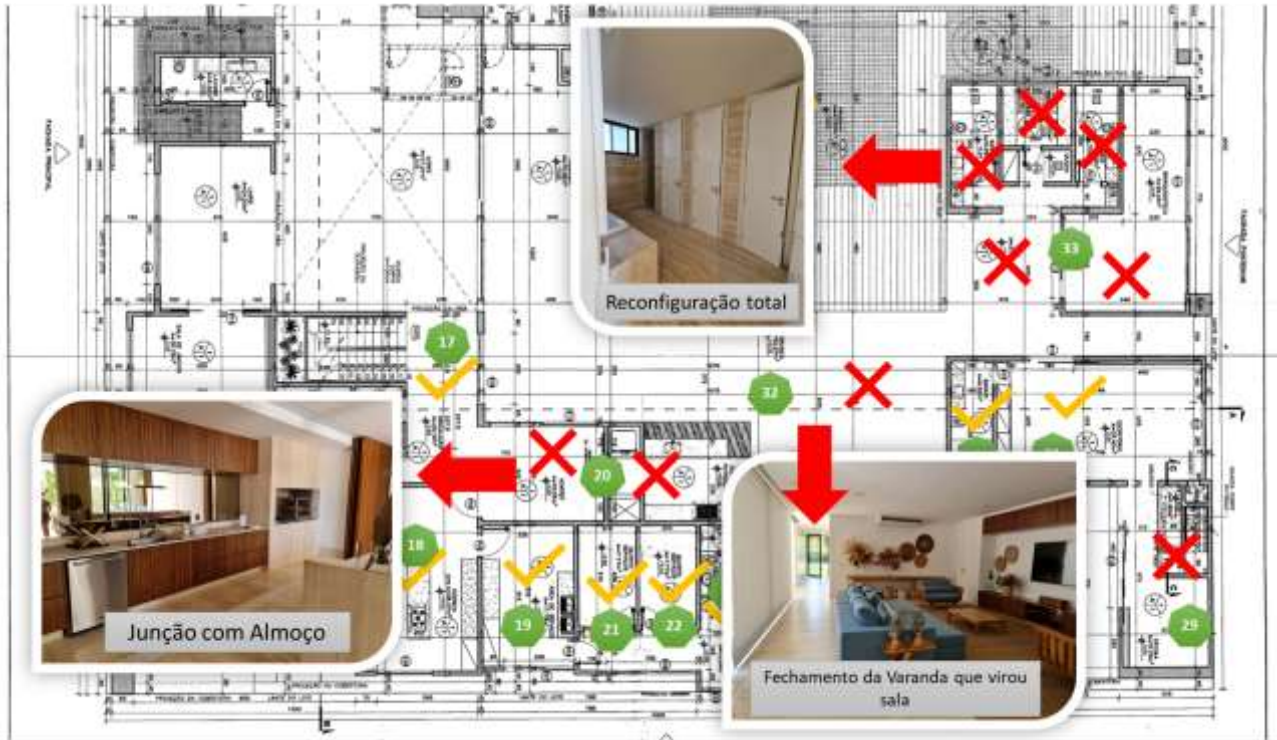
Divergências do Projeto Aprovado X Executado – Térreo (Parte 2)
